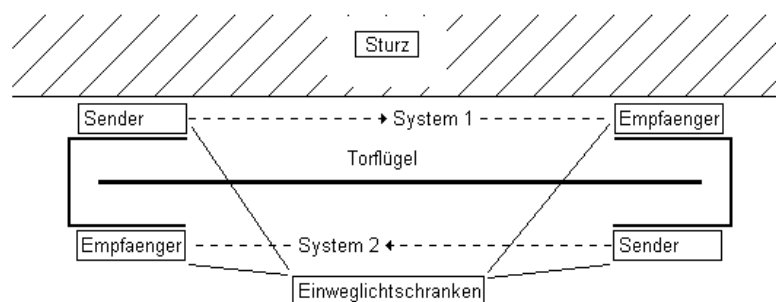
Beispiel Montageanordnung Einweglichtschranken
